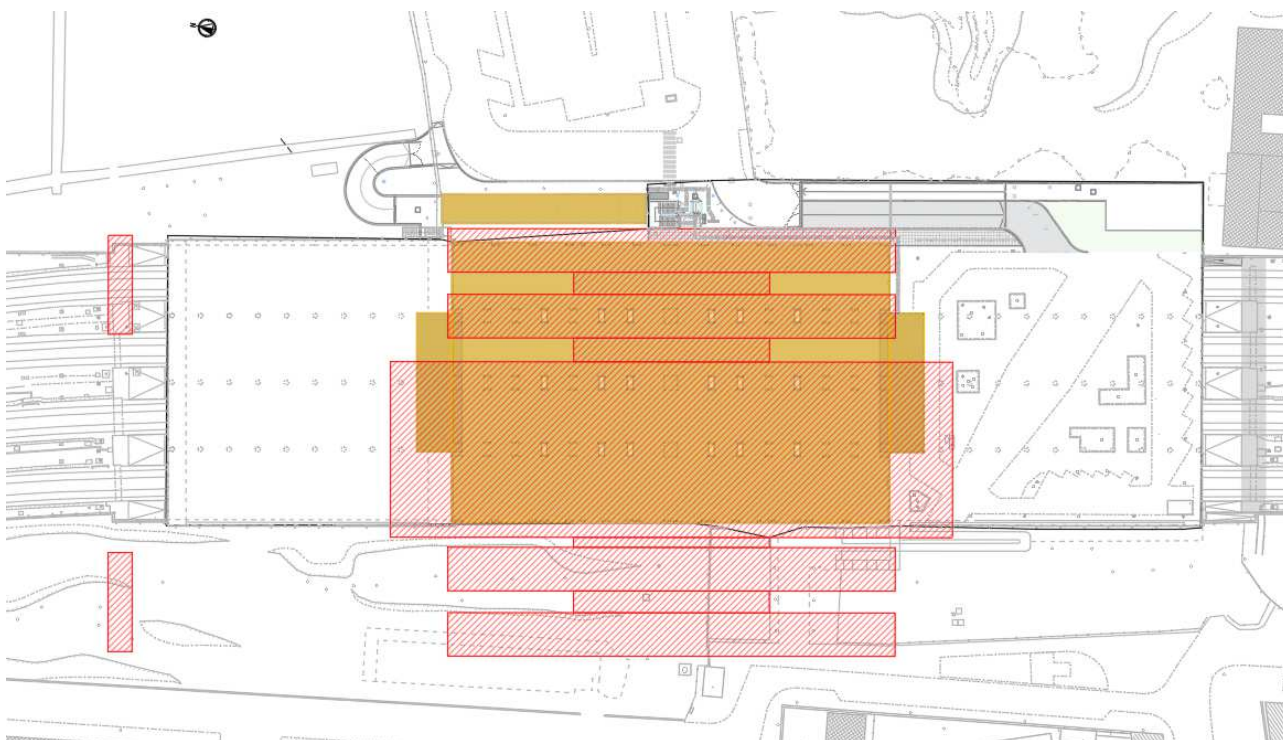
Planimetria demolizioni Piano Coperture Stazione di Bovisa (demolizioni in giallo)
